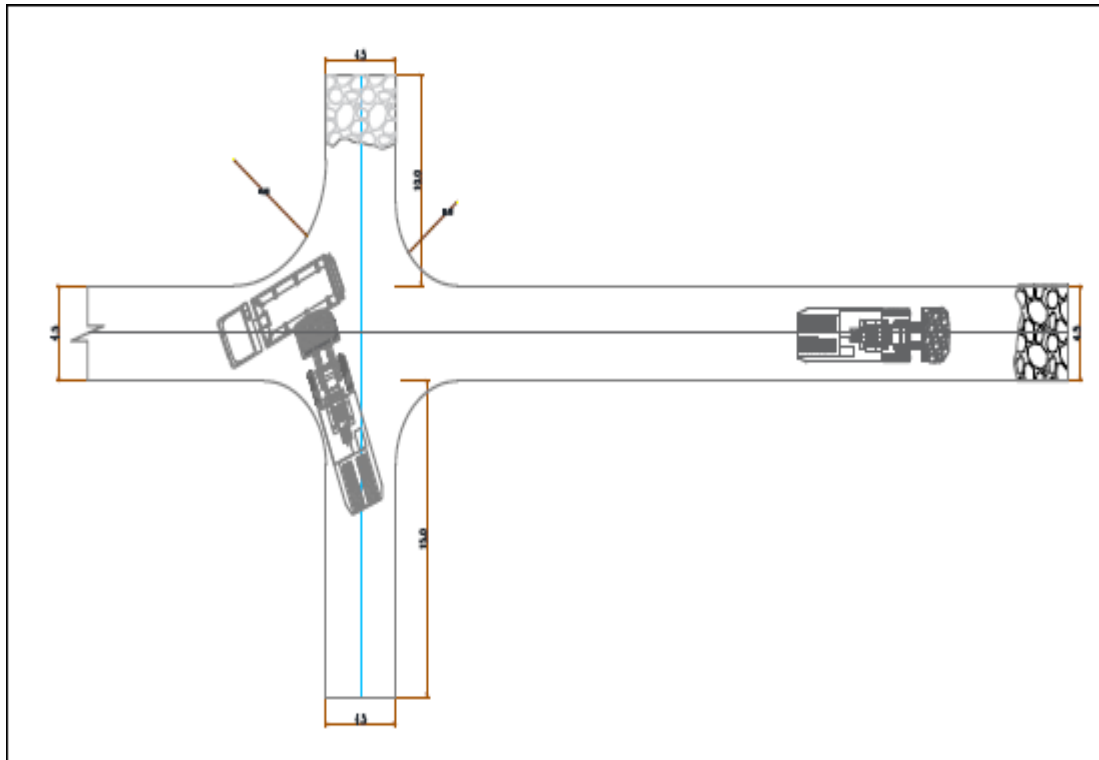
Vista en planta de detalles en específico de la cámara de carguío
